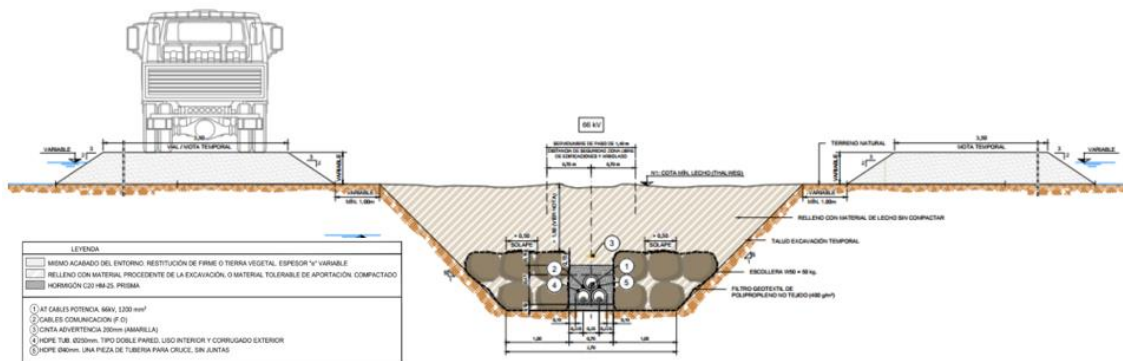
Sección tipo 4: zanja en 66 kV, cruce de cauces.
